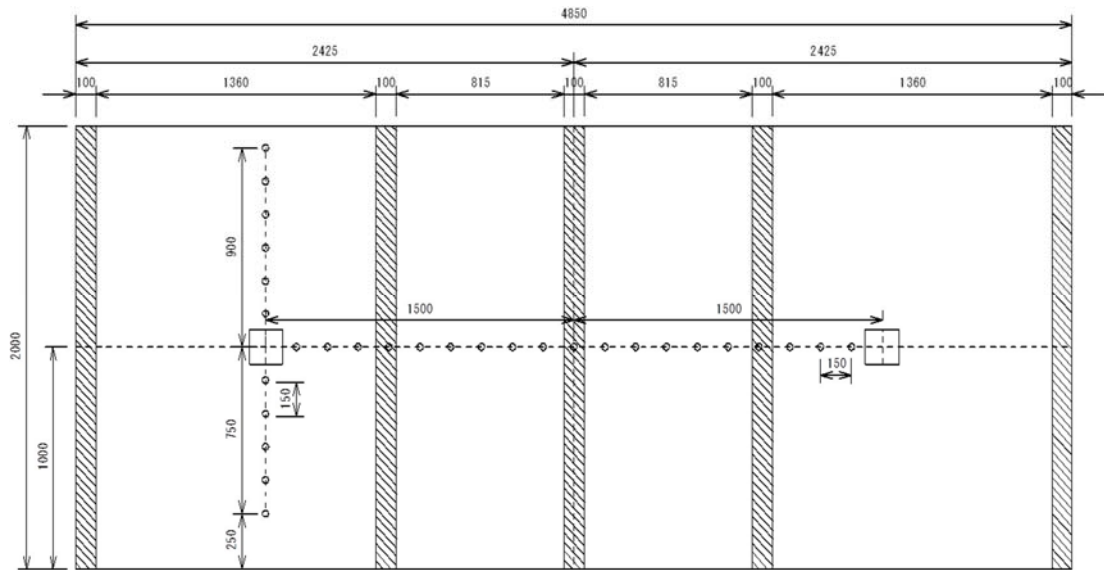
大型試験体の型枠パイプレイアウト配置図
